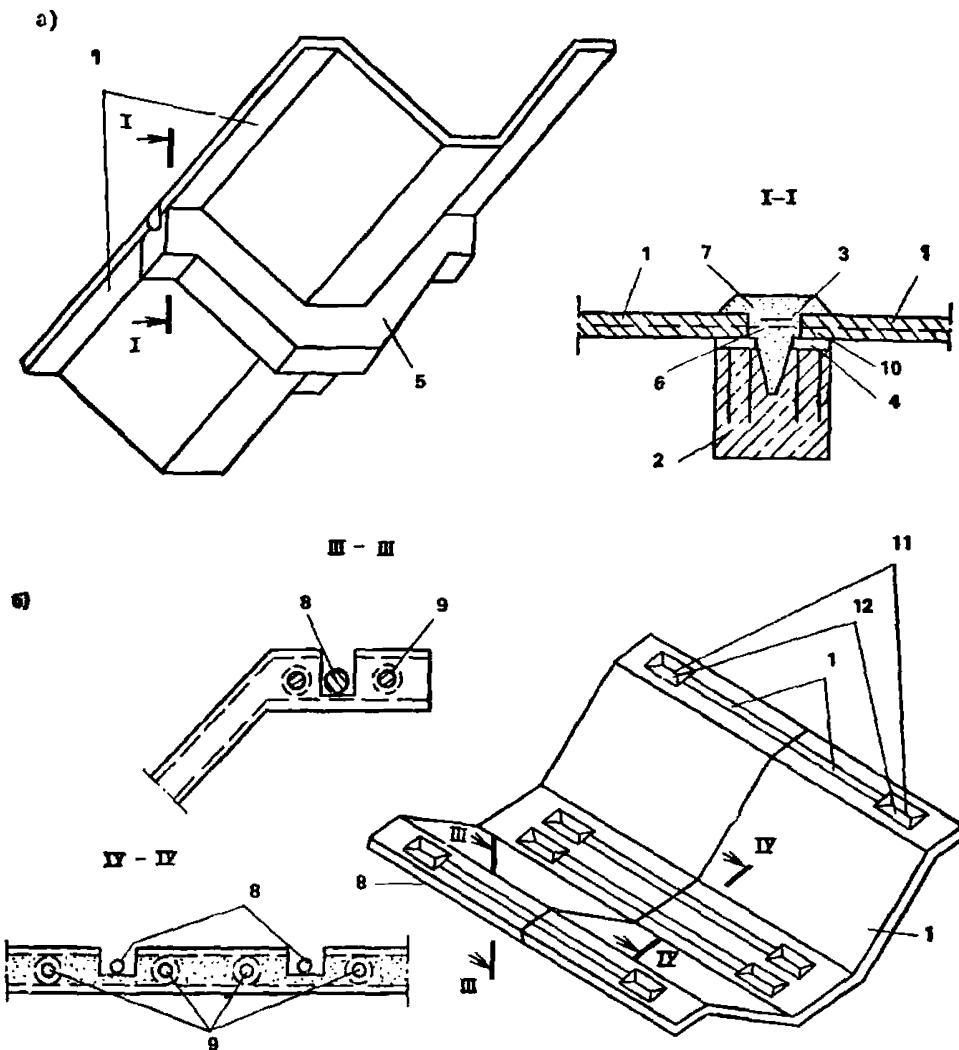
Стыки складчатых сборных армоцементных конструкций, работающих на внерадиальное сжатие и поперечную силу
